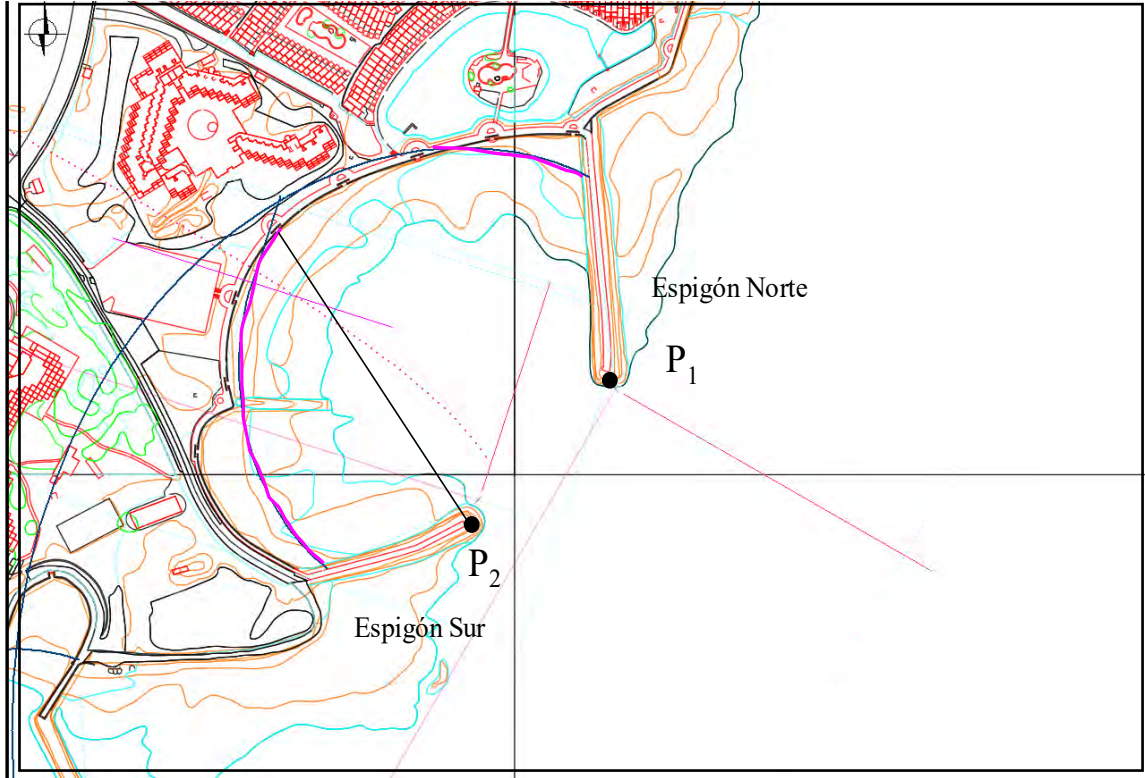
Forma en planta de la situación actual de la playa. Fuente: elaboración propia
